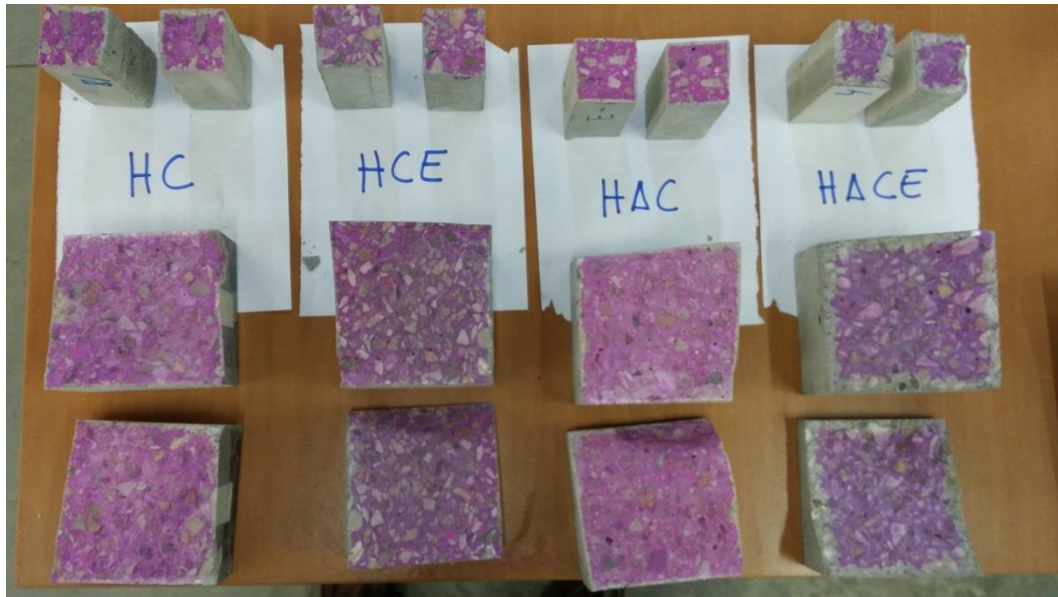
Probetas rociadas con fenolftaleína. Tipos de hormigón HC, HCE, HAC, HACE
